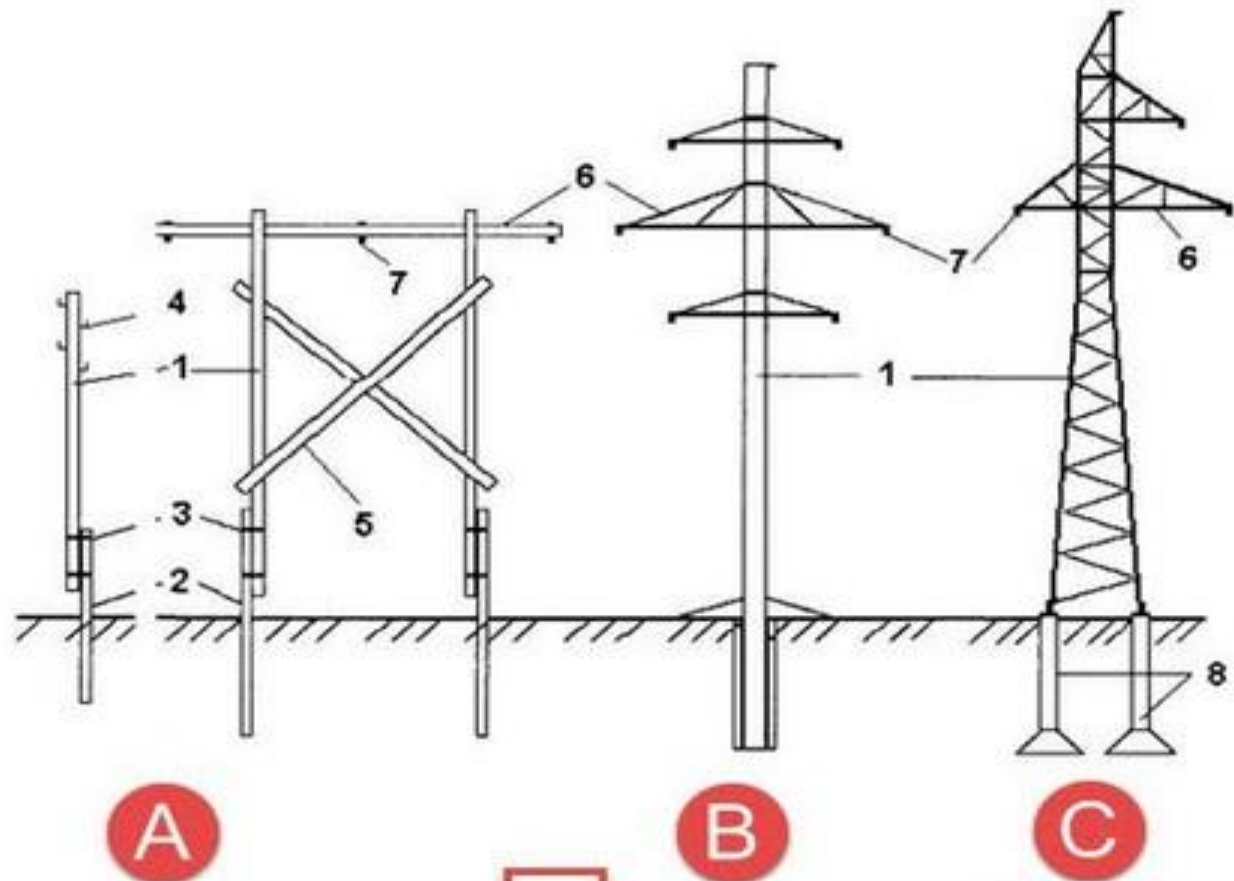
Деревянные A железобетонная B и стальная C опоры ВЛ.:
